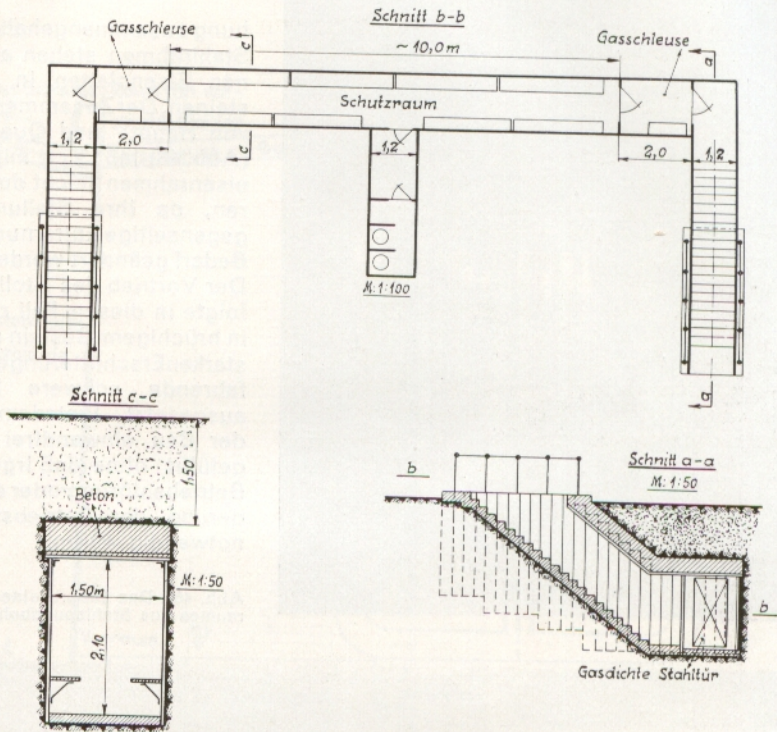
Grundriß und Schnitt eines Schutzraumes aus Stahlspundbohlen.
